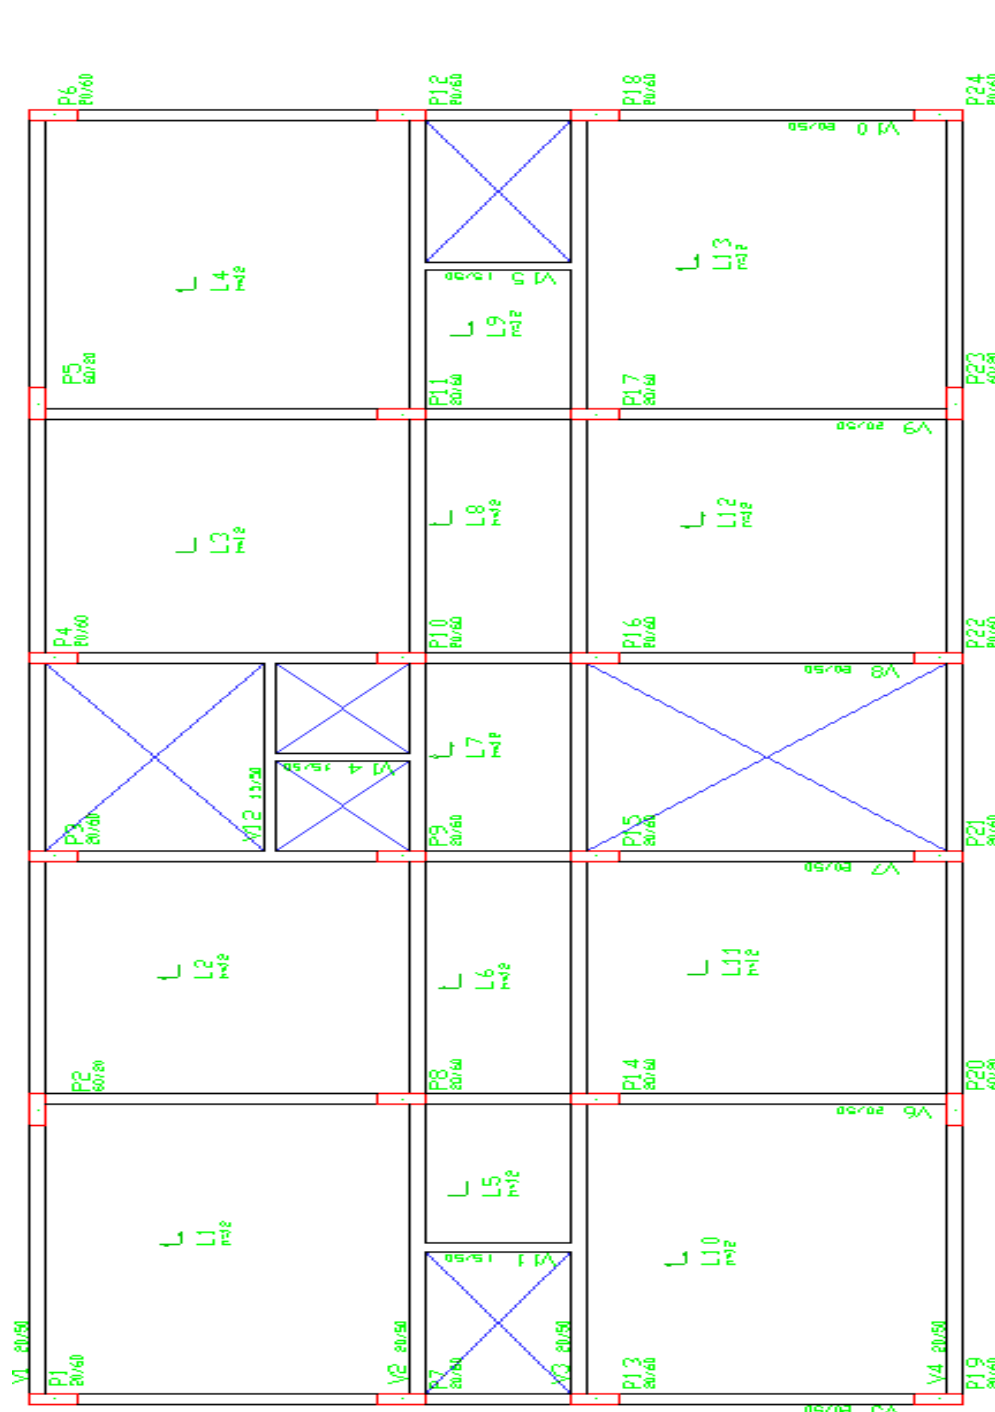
Representação das lajes, vigas e pilares para o pavimento tipo, obtido no TQS.
